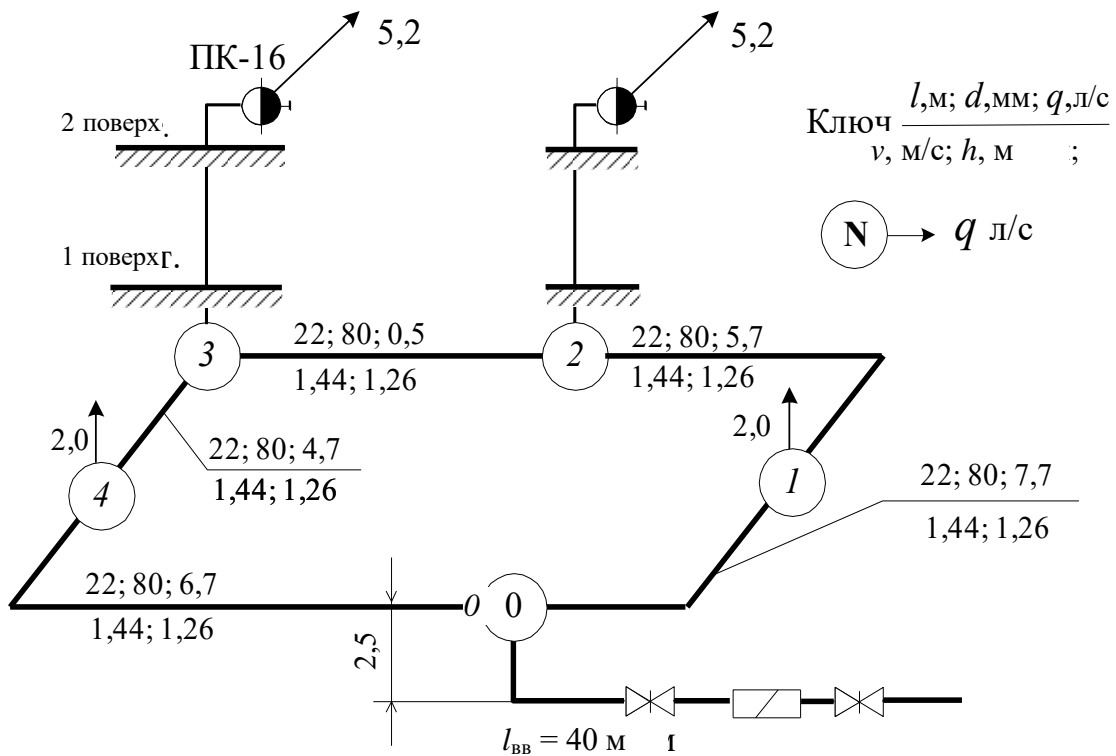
Розрахункова схема внутрішнього водопроводу
